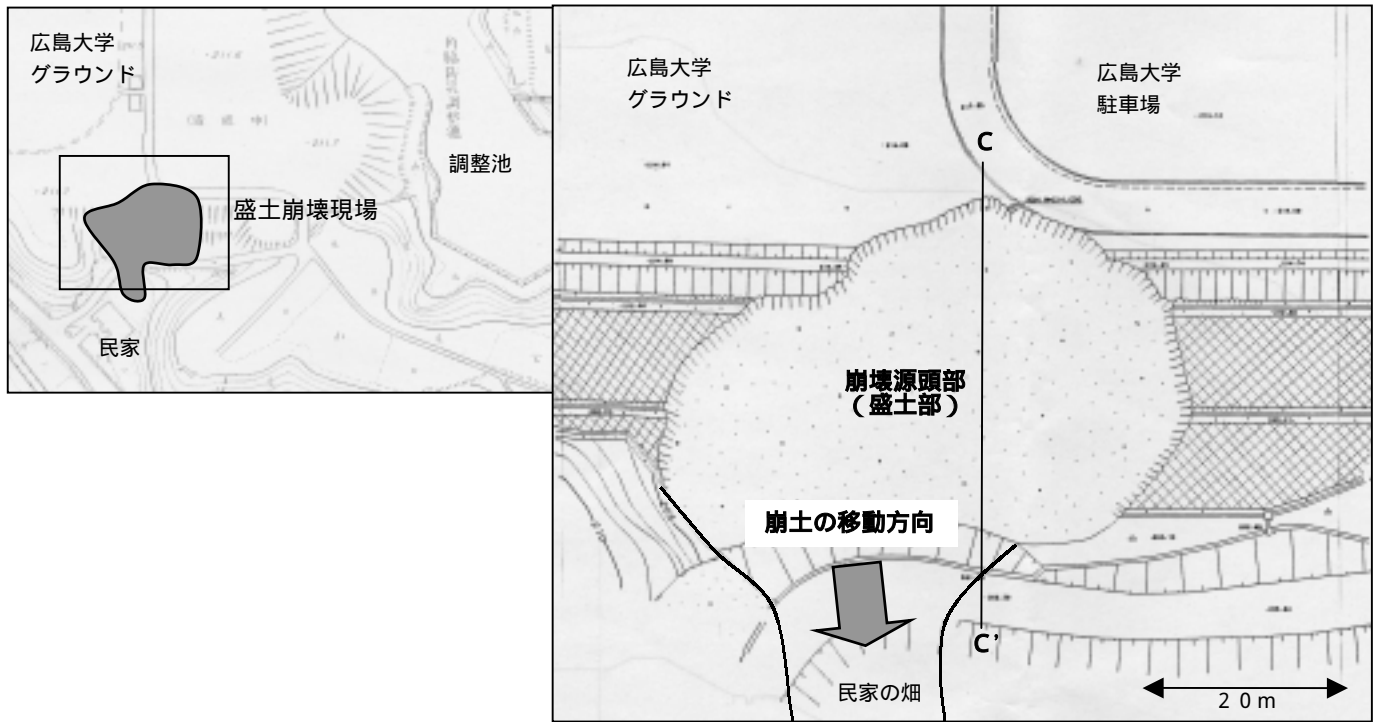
広島大学本部キャンパス南端の盛土崩壊の平面図
